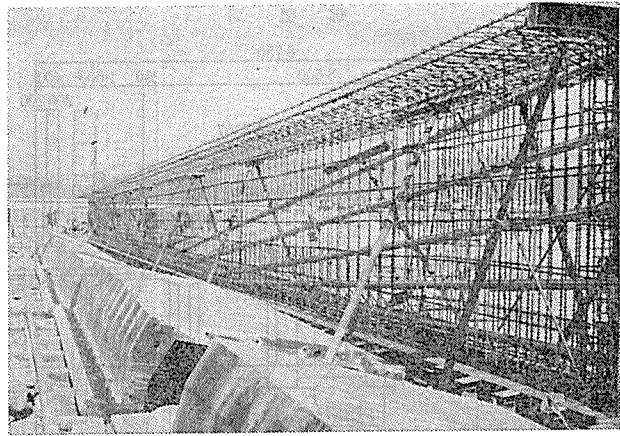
桁製作時の鉄筋組立て、ケーブル配置
